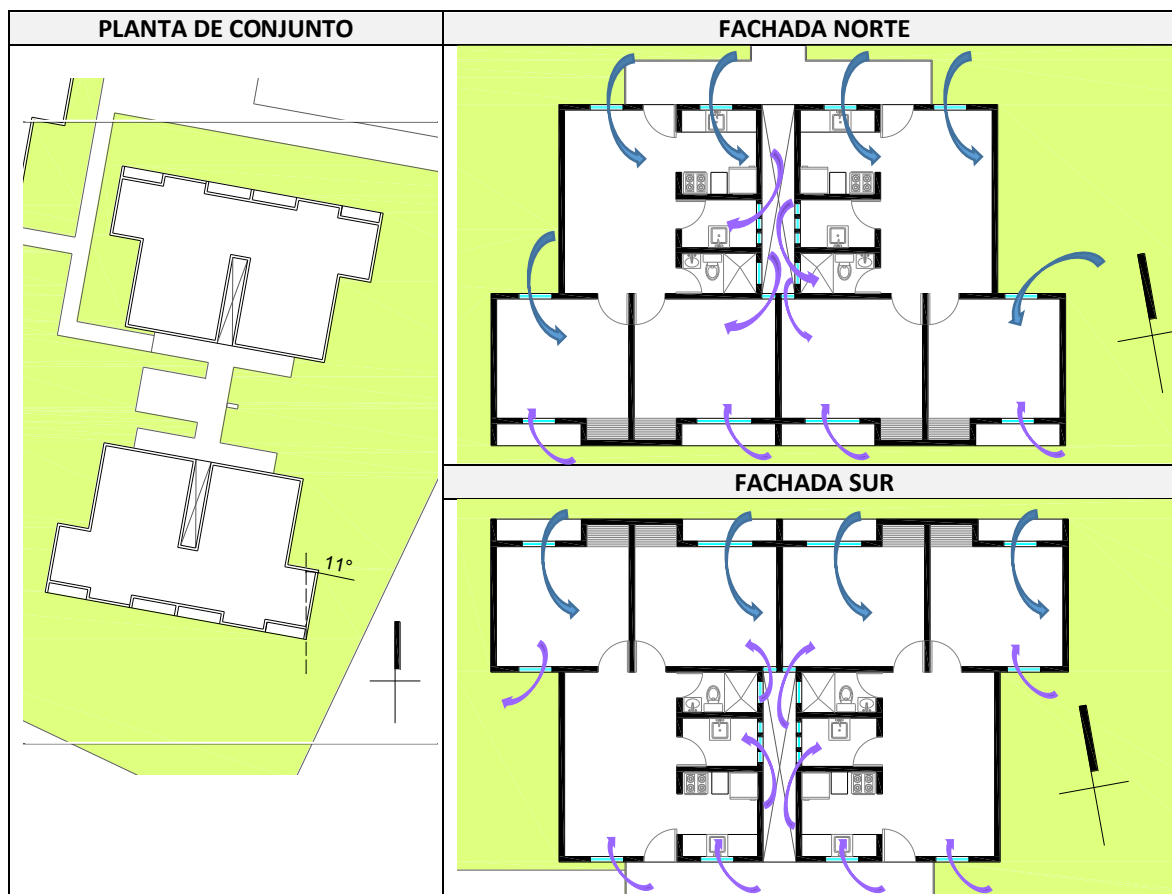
Ventilación de acuerdo a la orientación de la fachada: Vivienda vertical
